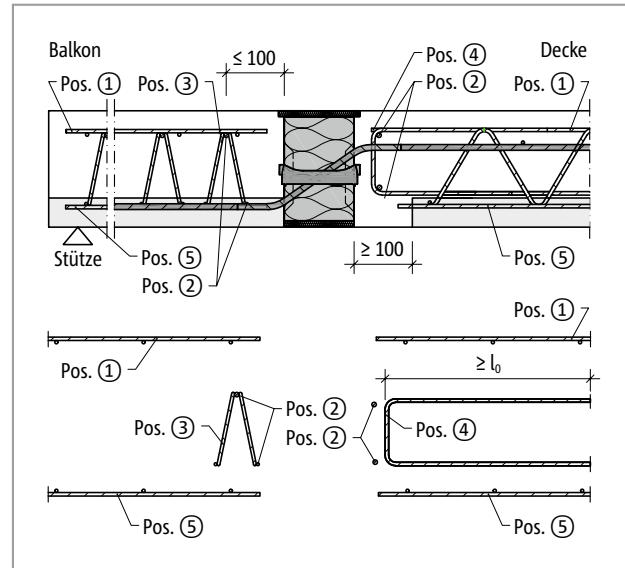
Schöck Isokorb® XT Typ Q-V5 bis V11 Bauseitige Bewehrung mit Gitterträger
